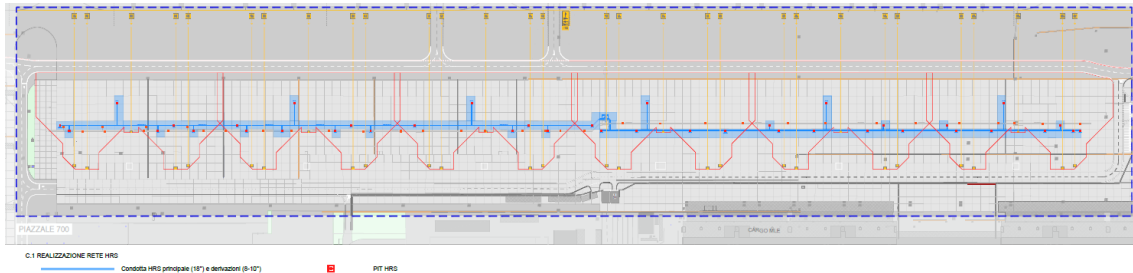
Andamento planimetrico della nuova condotta di alimentazione carburante HRS
